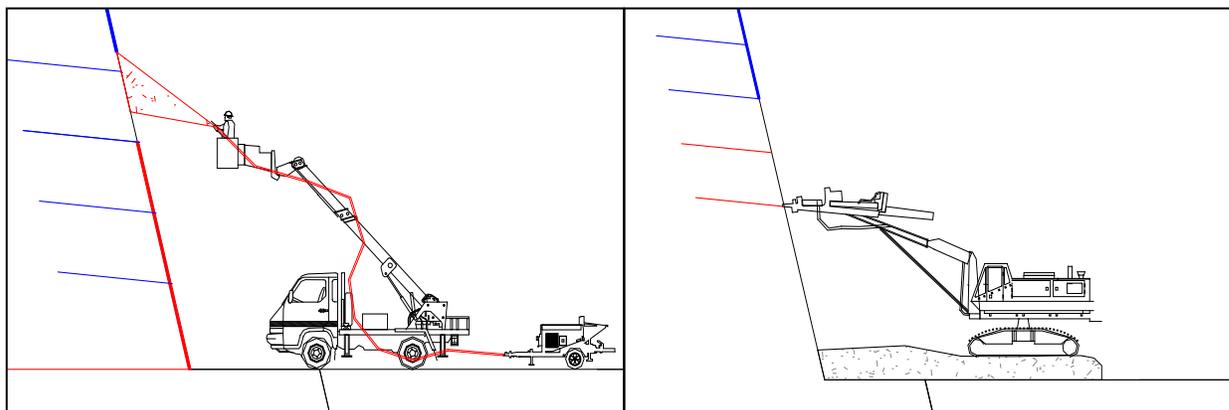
Concreto lanzado, drenajes y colocación de anclajes
